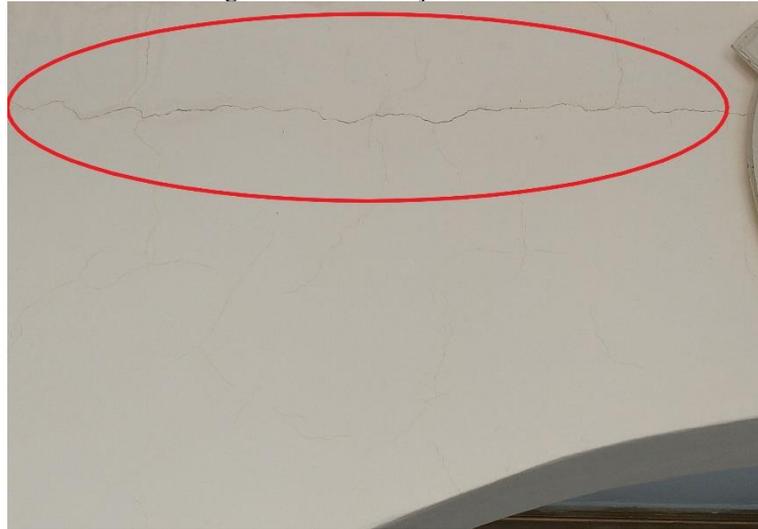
Fissuras por retração térmica do revestimento em parede de alvenaria.
